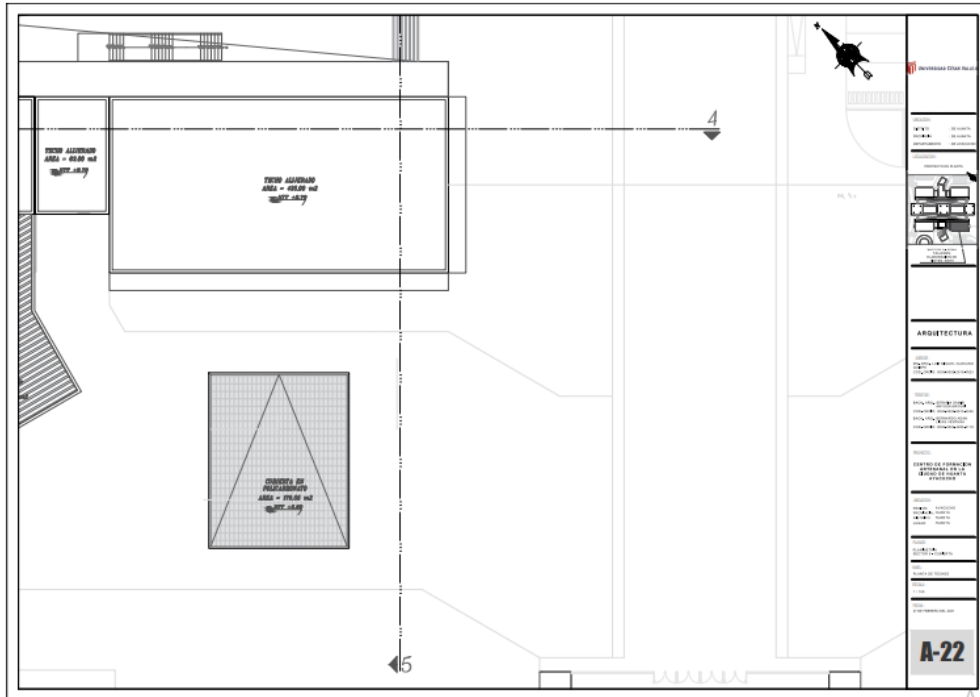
Planimetría de techos del sector 5. Escala 1/100.
